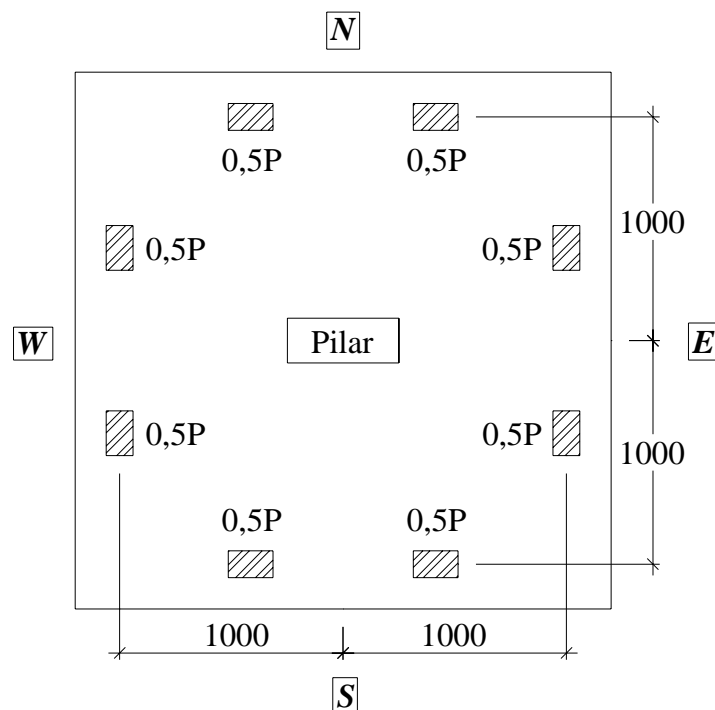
Carregamento das lajes da Série 1: L1 a L7, L9, L16 e L19 (dimensões em mm)
